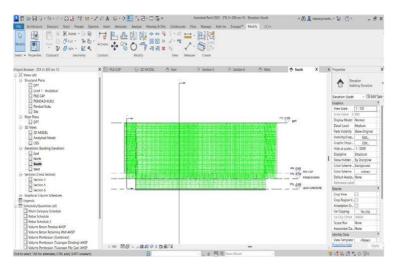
Tampak depan struktur DPT Sta.3+300.
